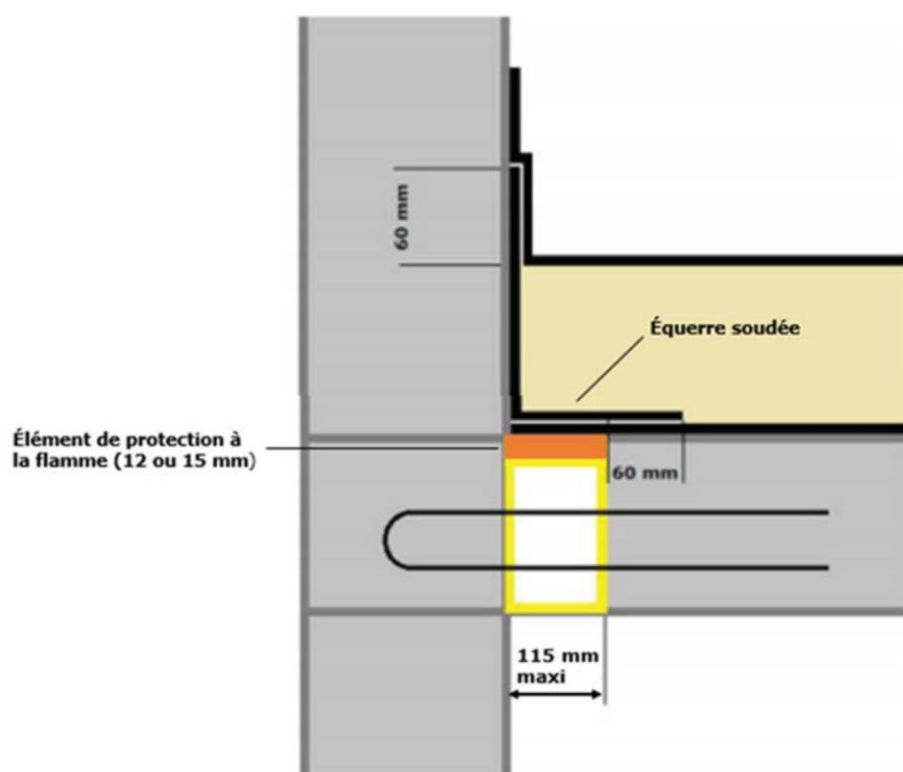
Rupteurs avec un élément de protection à la flamme posés en planchers (coupe verticale)
